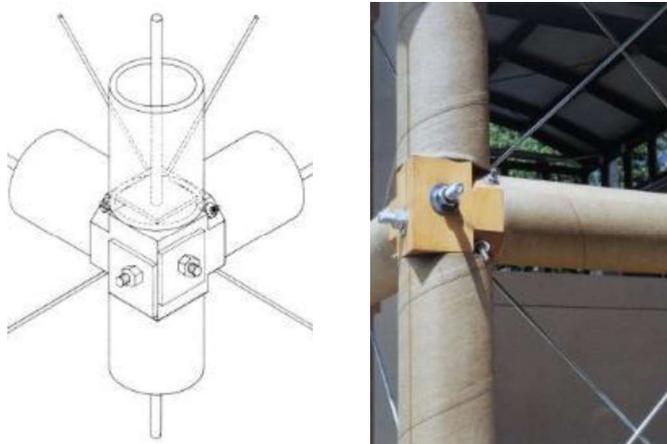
e 16 – Conexões metálicas articuladas empregadas nas obras de Ban
